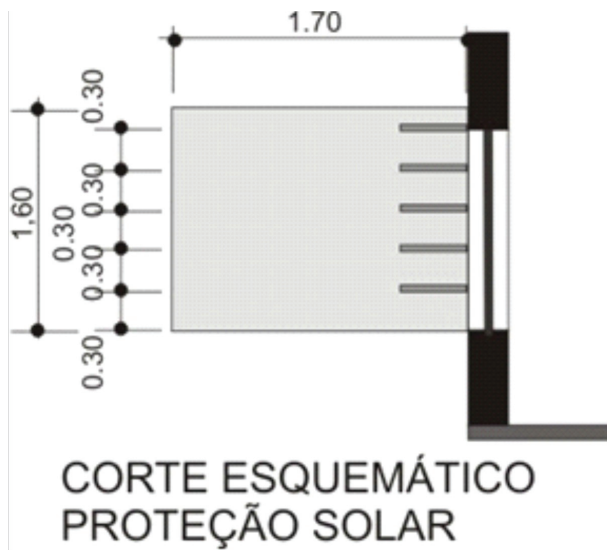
Projeto do sistema de proteção solar, plano transversal.
